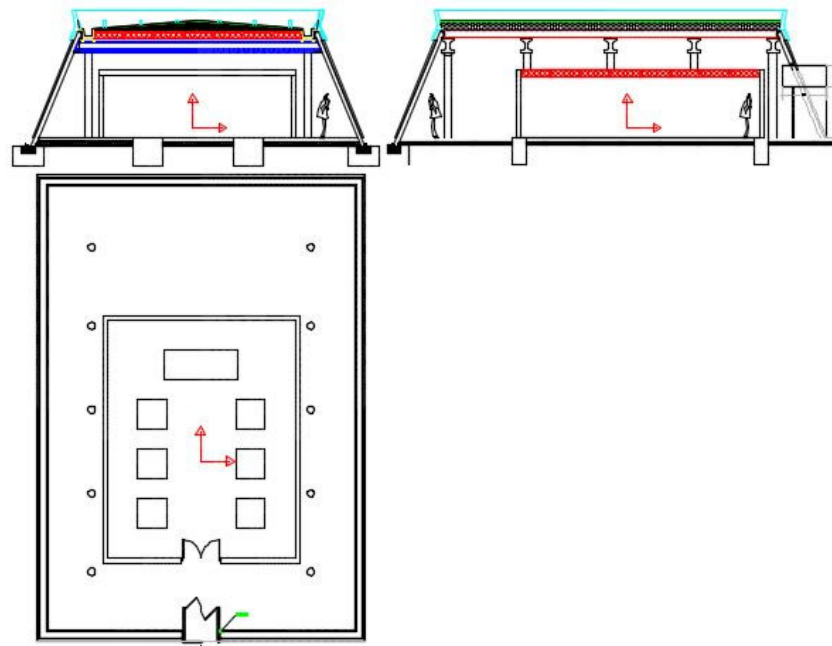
Vistas del Pabellón de Gravimetría de Yebes. El alzado (arriba a la izquierda); perfil (arriba a la derecha); planta (abajo a la izquierda). En todos los casos el norte queda definido en dirección a la puerta de acceso.
